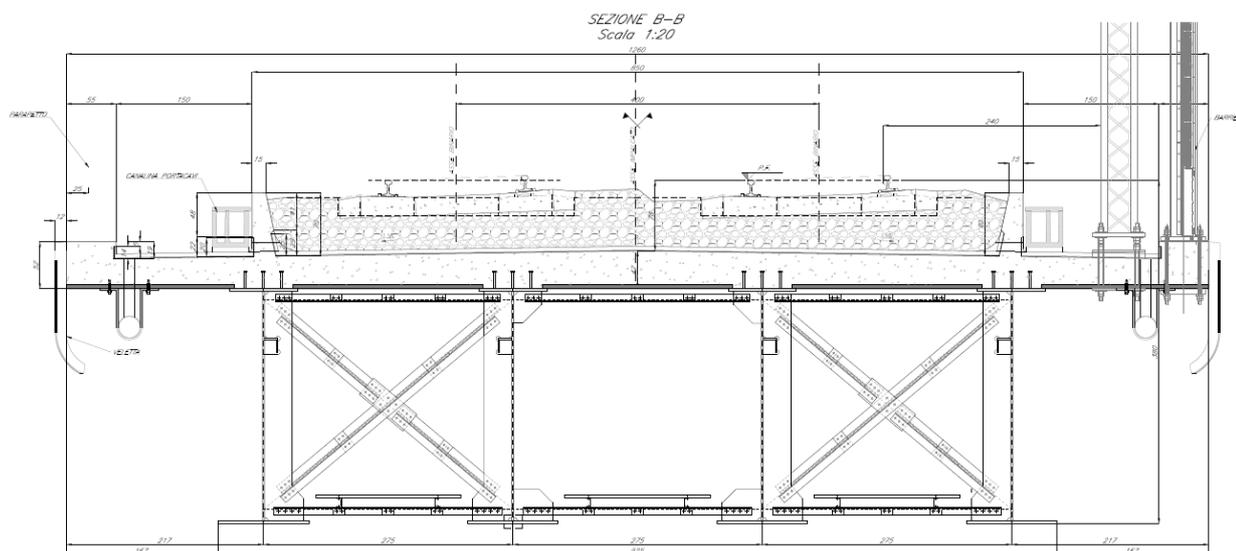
Sezione trasversale dell'impalcato misto a 4 travi
